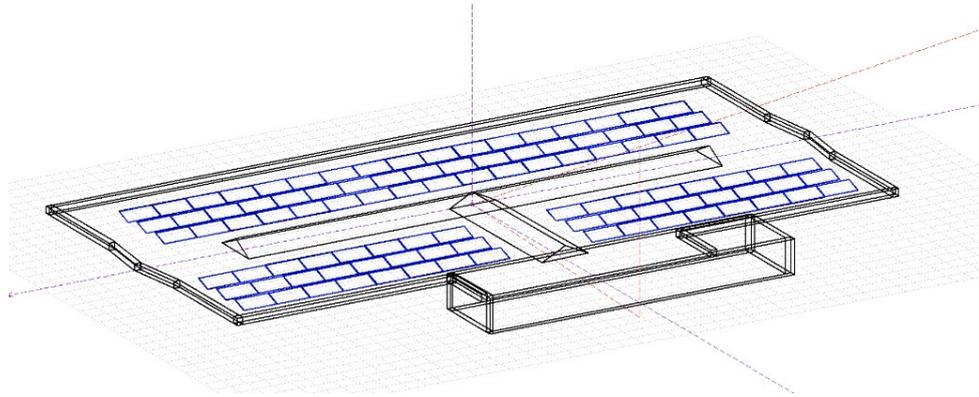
Colocación de paneles en la cubierta del edificio de la escuela politécnica de Teruel.
